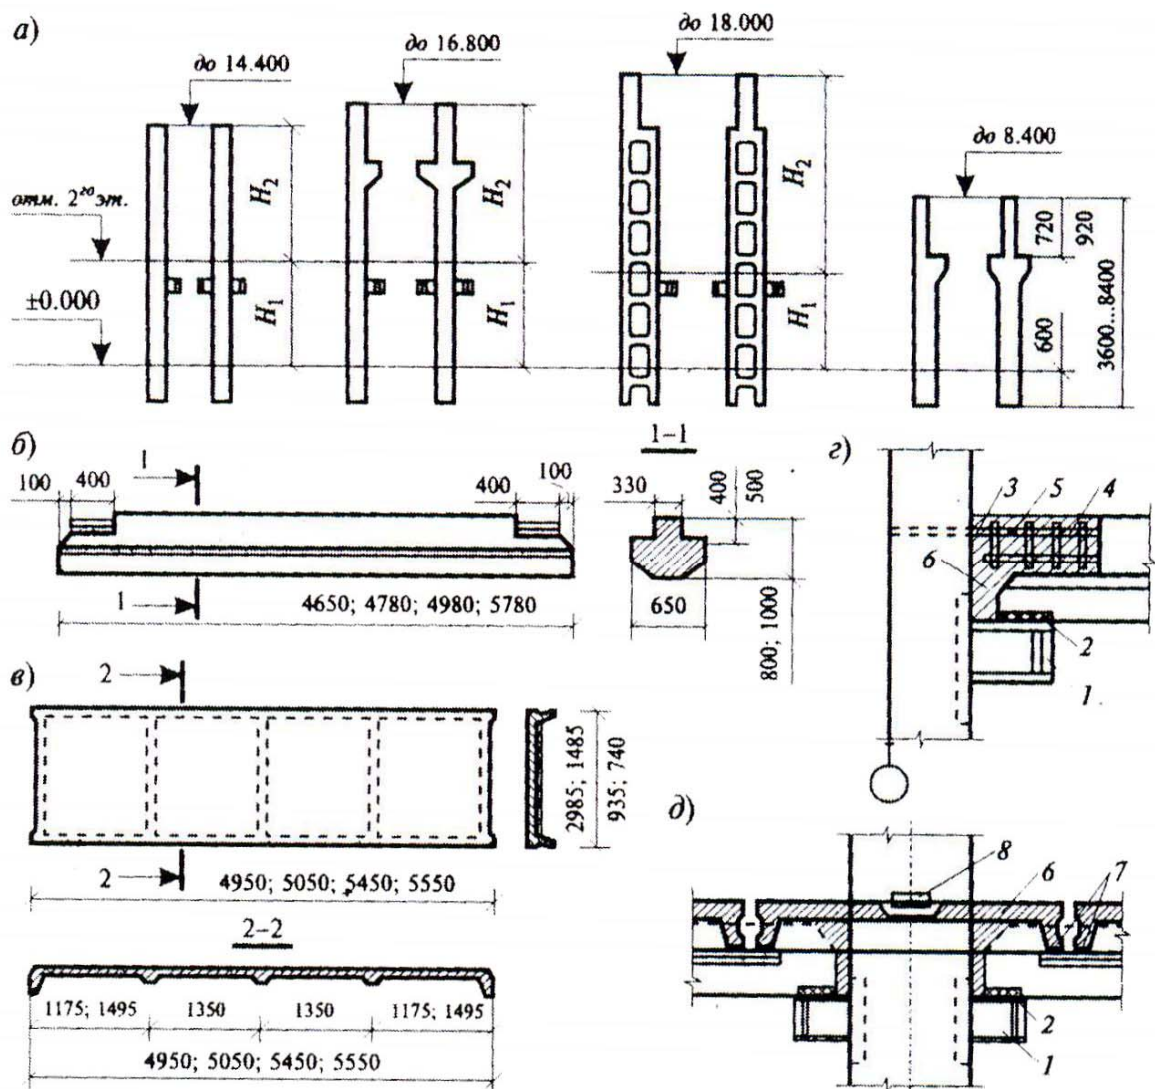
Сборные железобетонные конструкции двухэтажных зданий:
